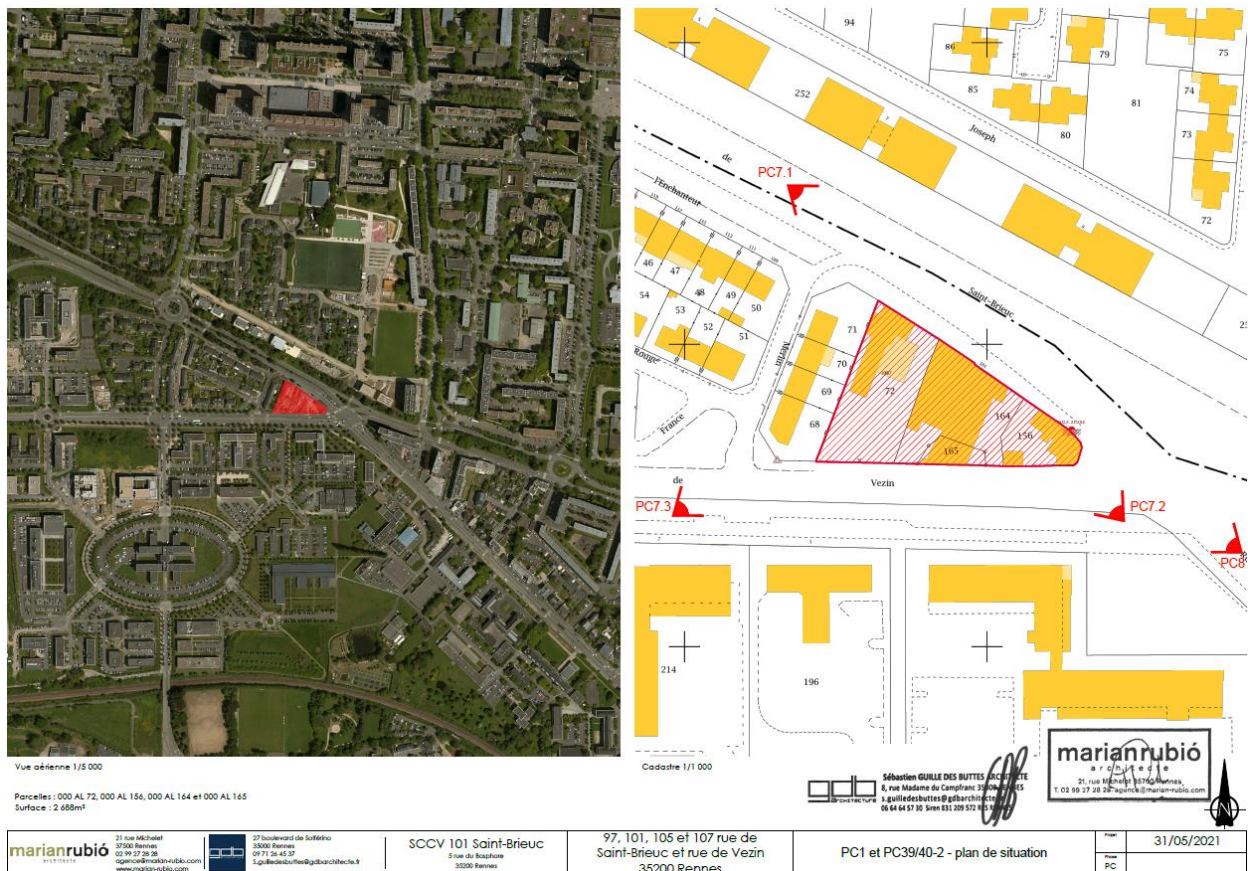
Plan de situation issu du PC - Marian rubio architecte
